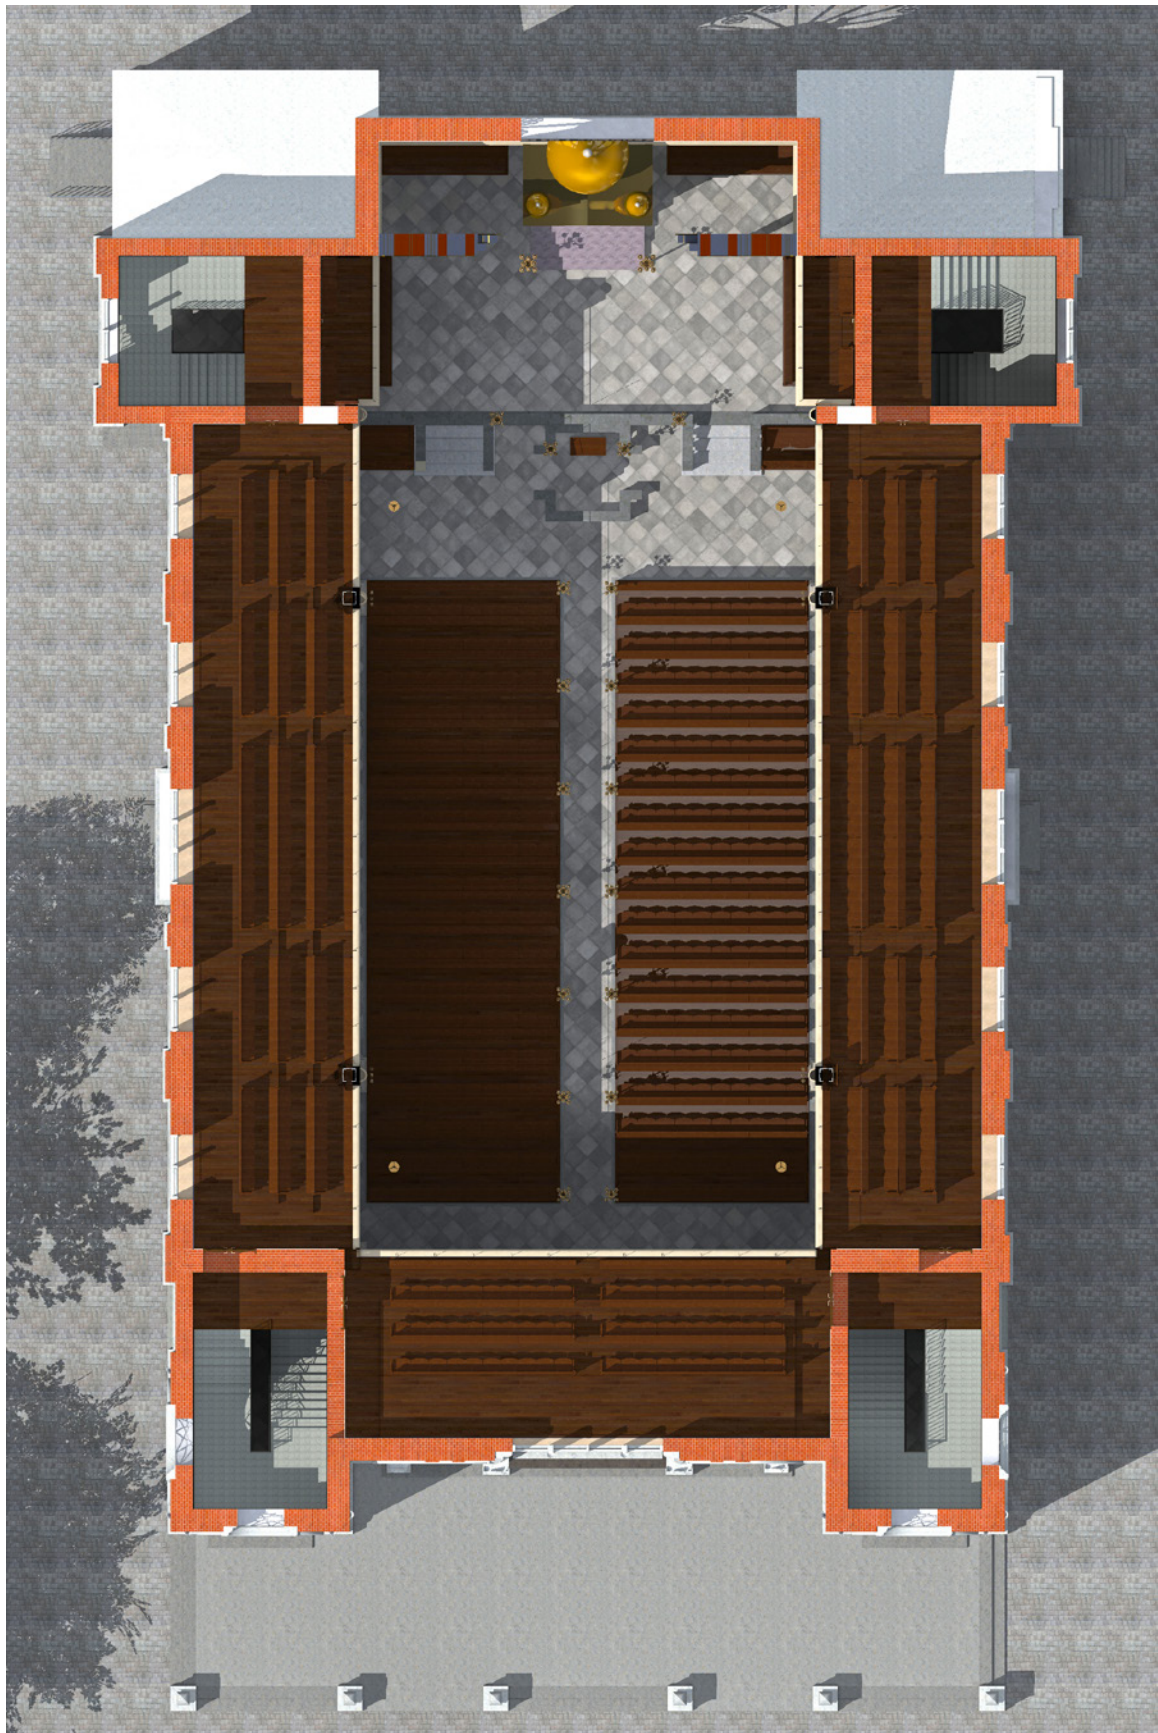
3D Grundriss - 2. Galerie
